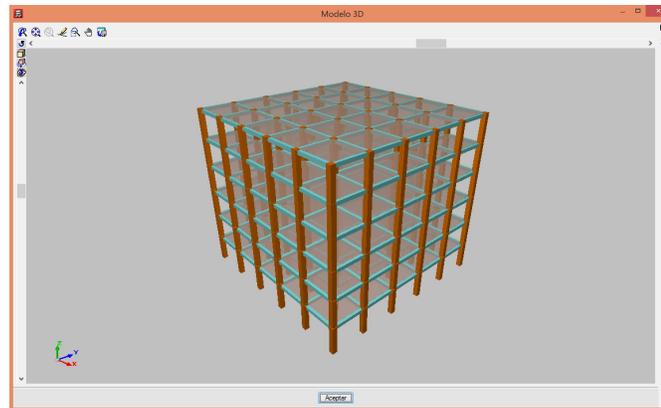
Vista en 3D de columnas y vigas del edificio
